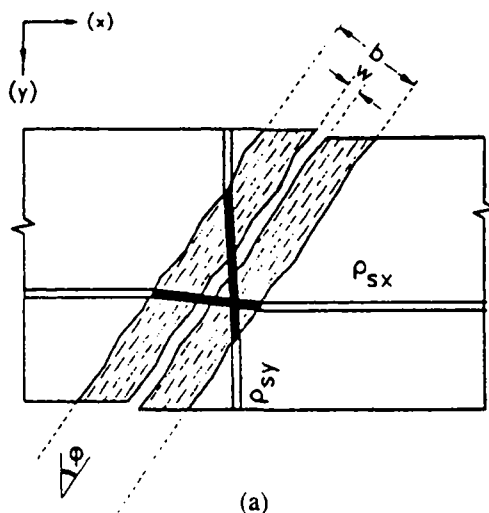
Flexion locale des barres d'armature au droit d'une fissure [82]
